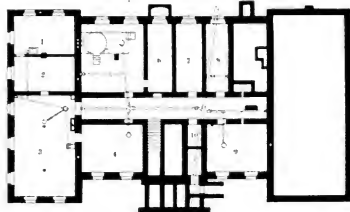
Grundriss vom Kellerschosse. — Masstab 1 : 200.
